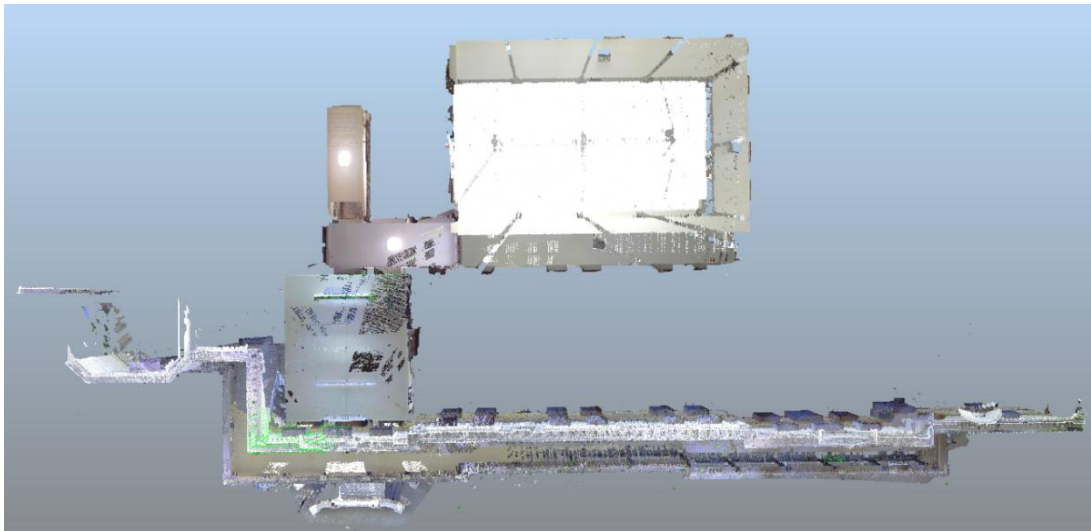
Modelo Digital 3D georreferenciado y texturizado de la fachada de rumbo SO y parte del interior del Edificio Central de la Facultad de Ingeniería. Vista planta.
